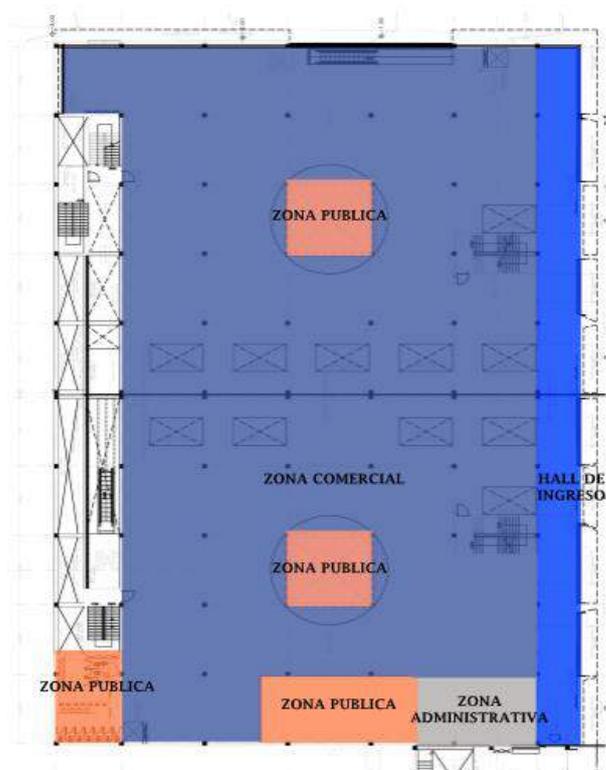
Plan Masa CC Juan Cajas. Planta Baja.
